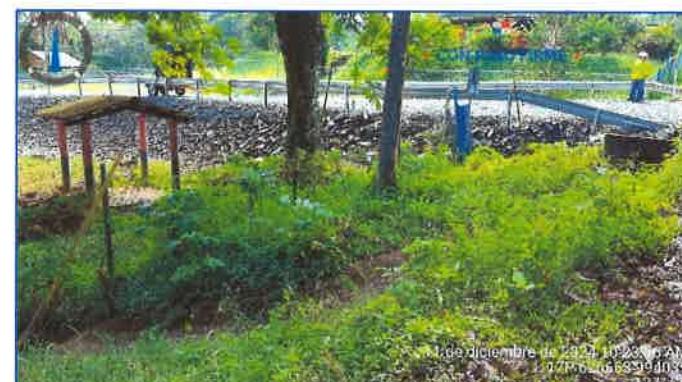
y 16. Zona de disposición final de materiales excedentes de la construcción vado.
